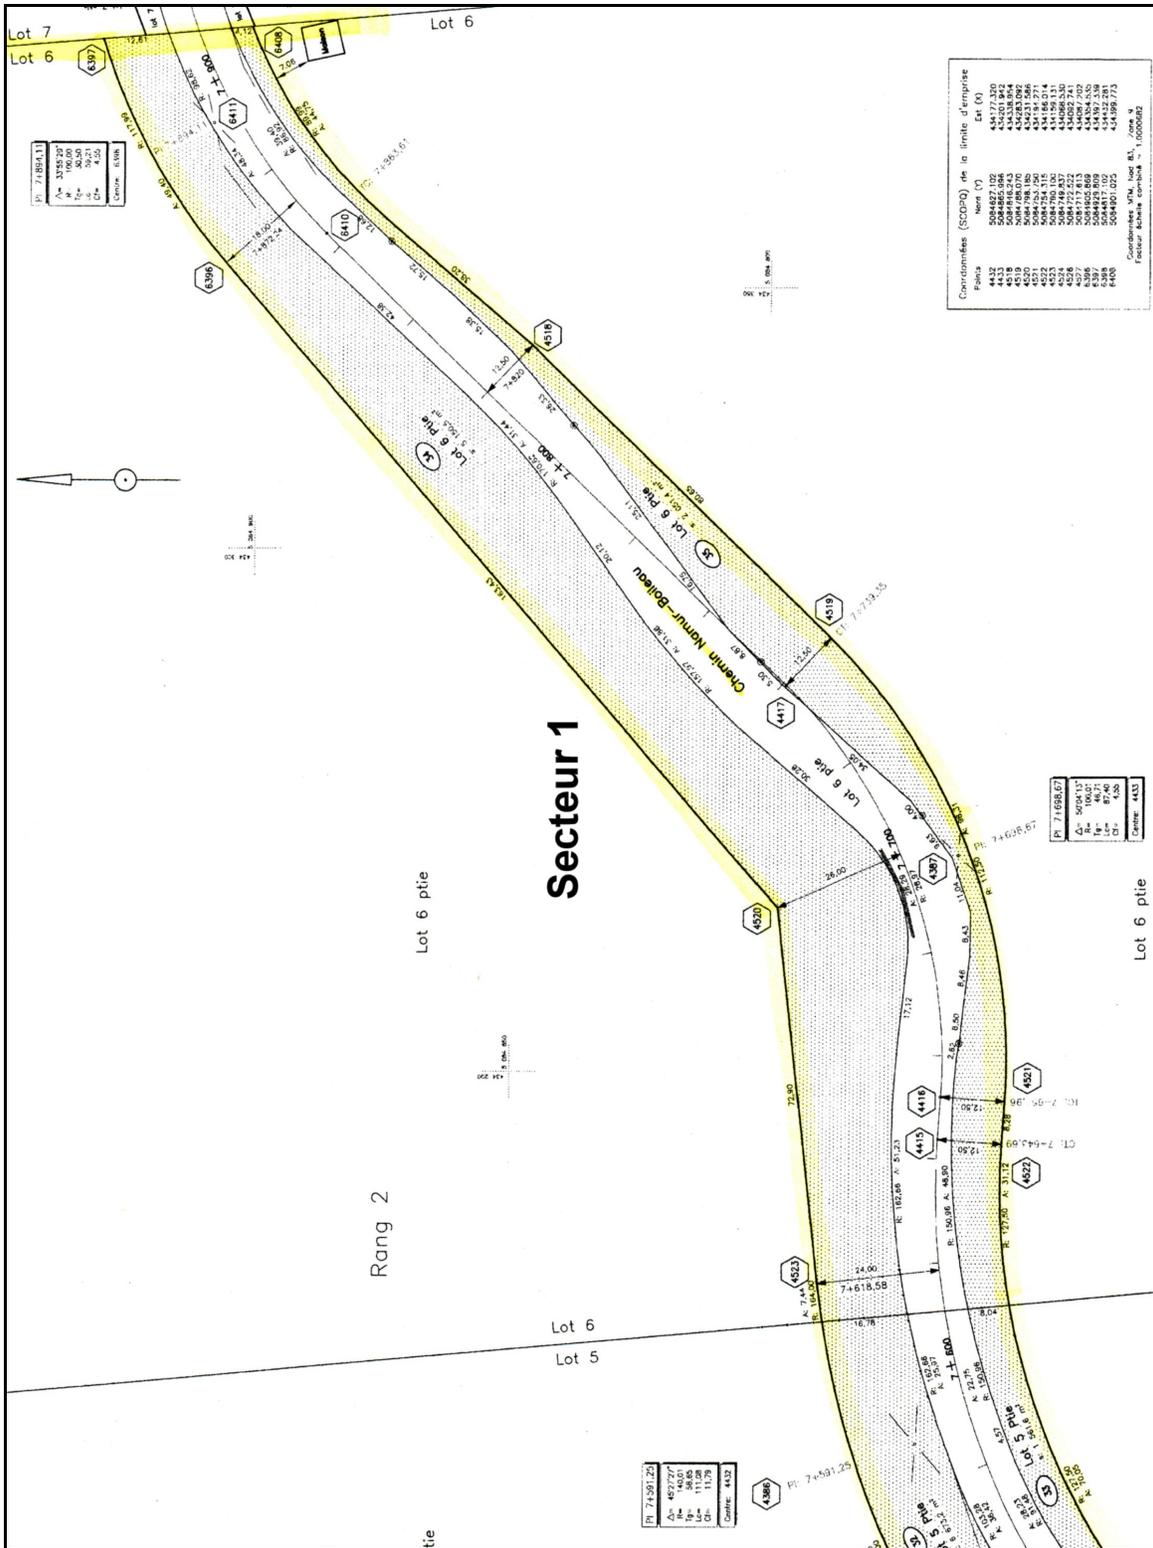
Localisation des secteurs d'inventaire sur le plan de construction du projet 20-6671-8035 (5/5)
